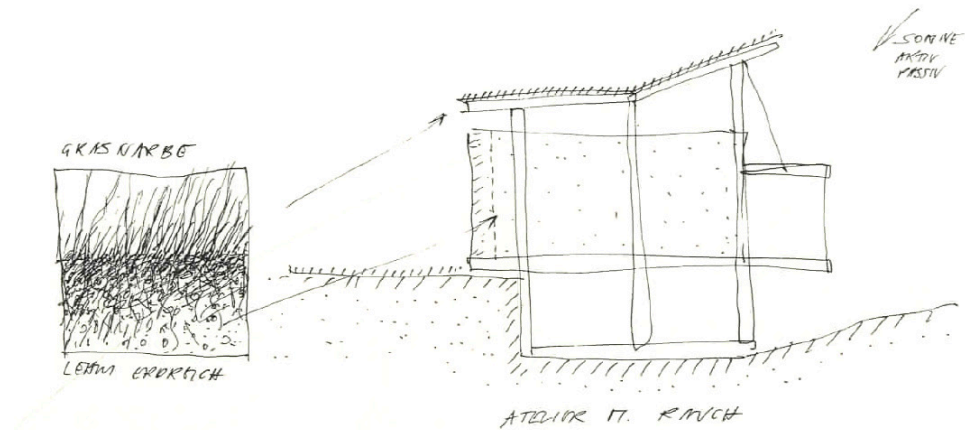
Estudio Rauch. Materialización de la fachada: muro en tapial, franja de adobes recubierto con esteras de caña como aislante y cubierta vegetal.
